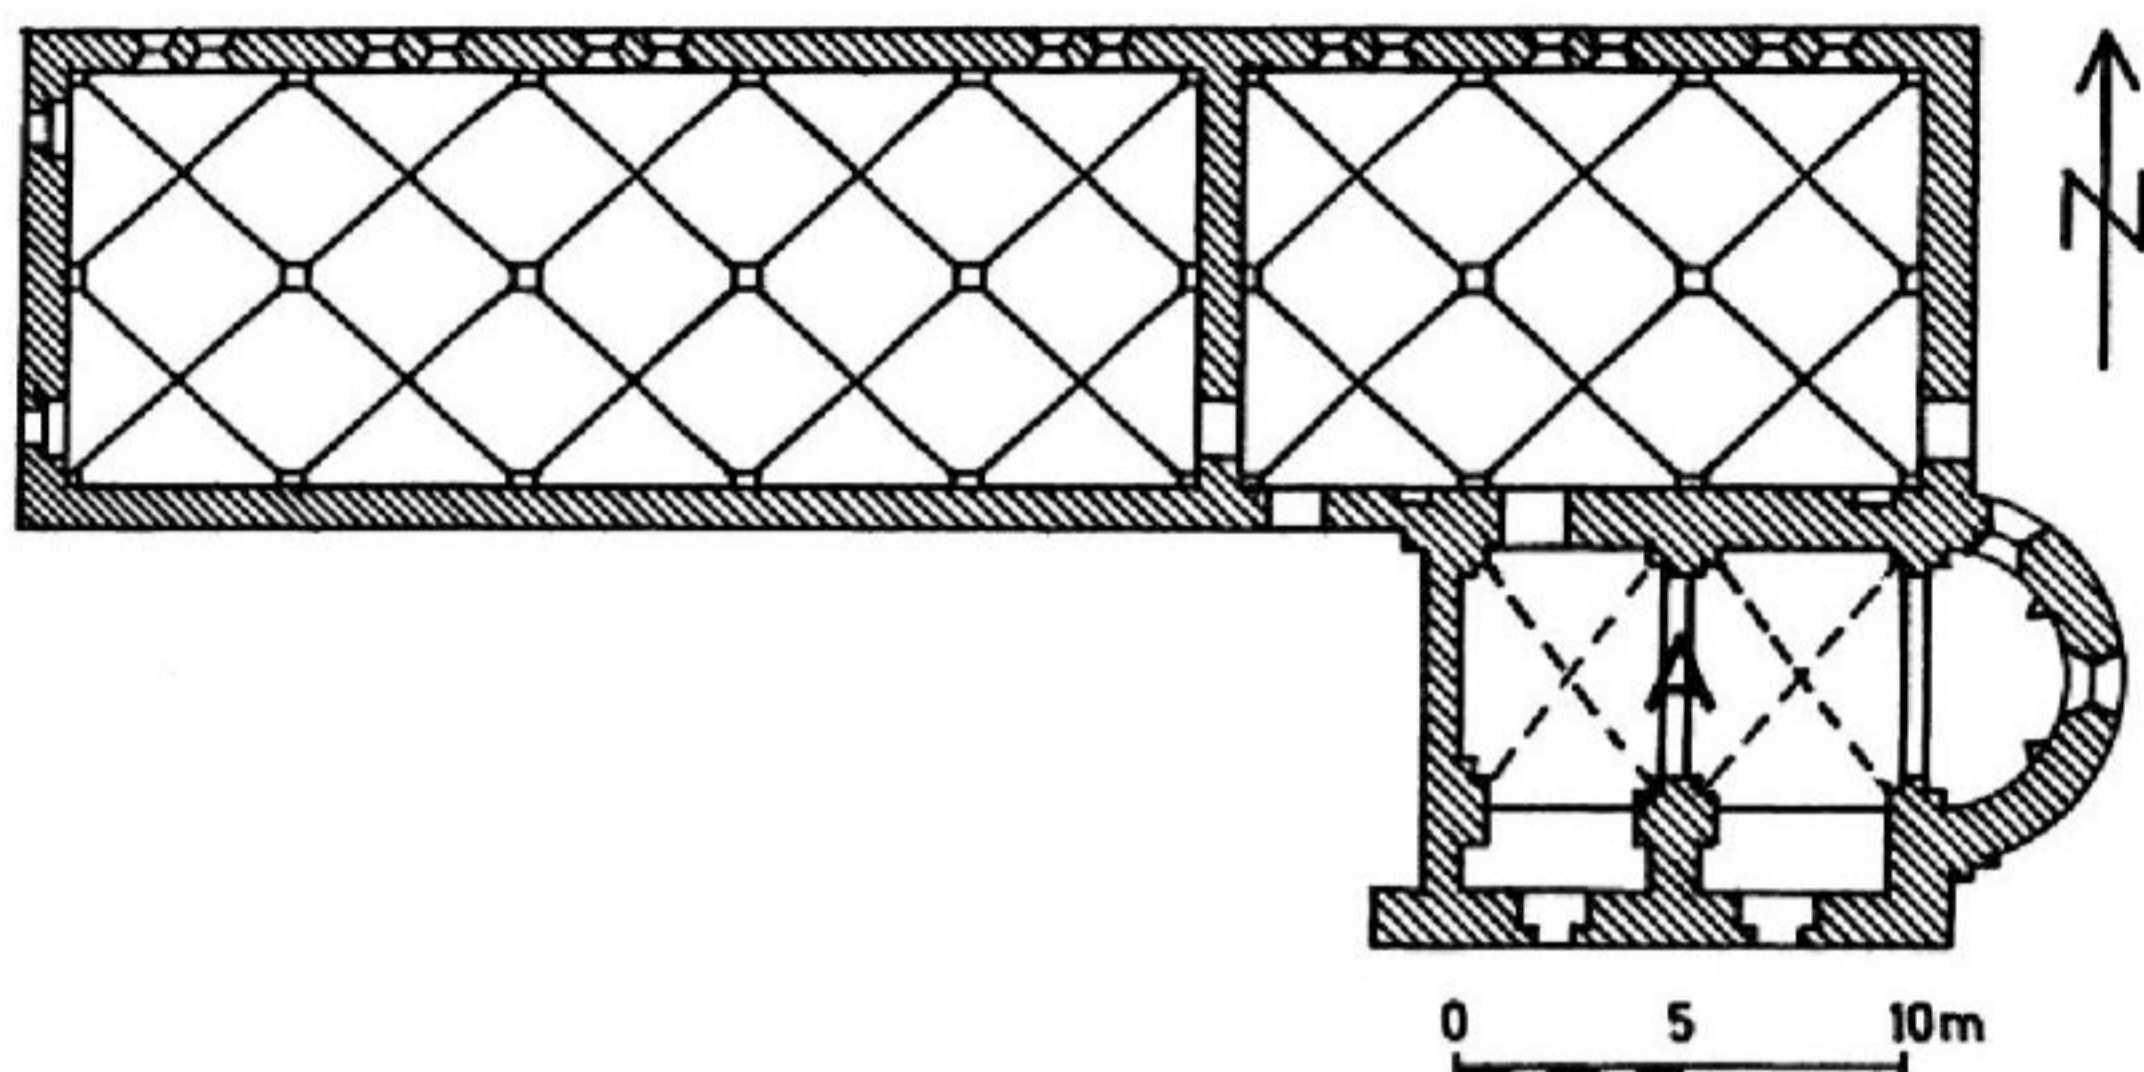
Meaux. Plan du rez-de-chaussée de l'évêché au XII<sup>e</sup> siècle, d'après O. JOIN-LAMBERT. – A: chapelle.
